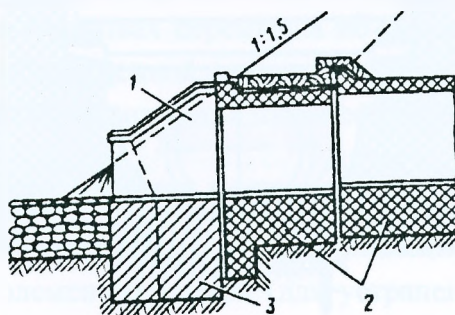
Удлинение трубы: 1 – новый оголовок; 2 – старая кладка фундамента; 3 – новая кладка.
